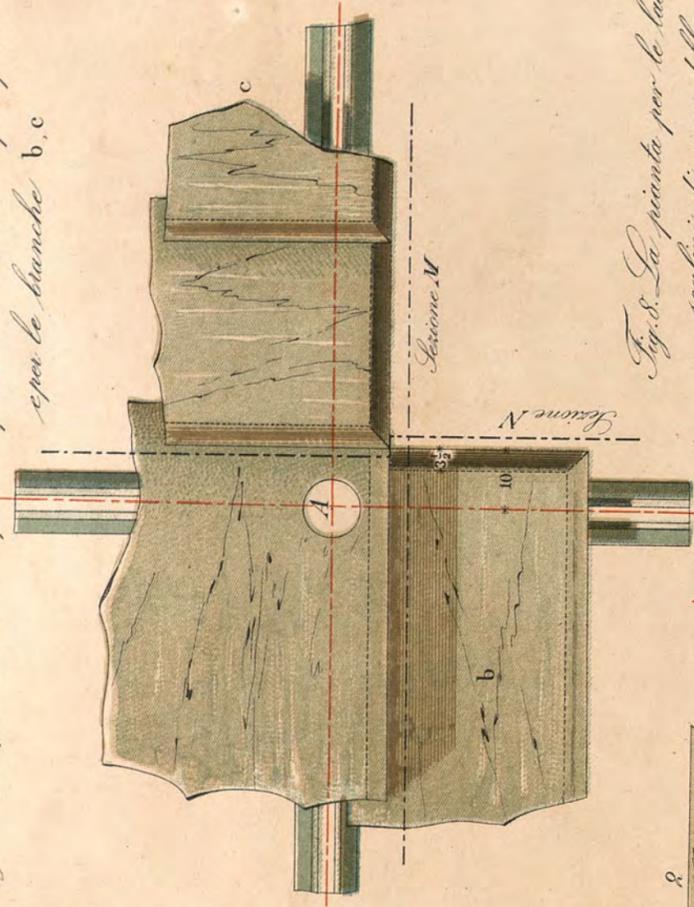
Un particolare in pianta per una porzione del pianciottolo 3 e delle banche a, c.
